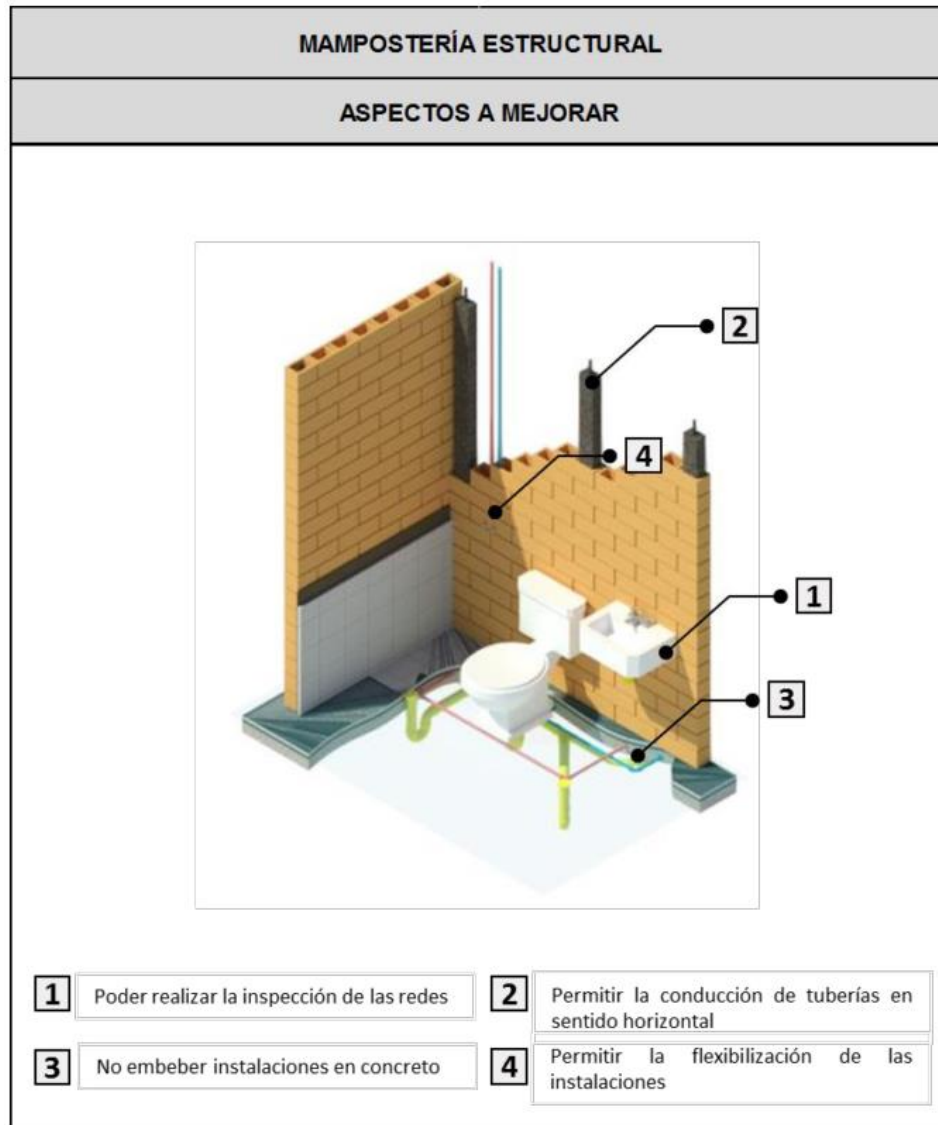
, Mampostería estructural, Aspectos a mejorar.
